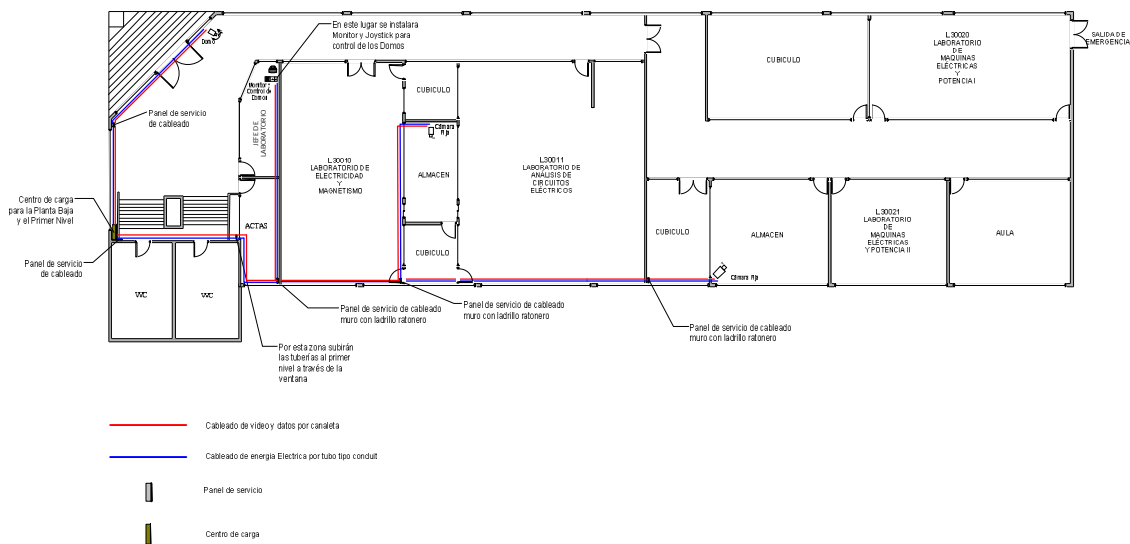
Tubería y canaleta para cableado de video y energía eléctrica en la Planta Baja
